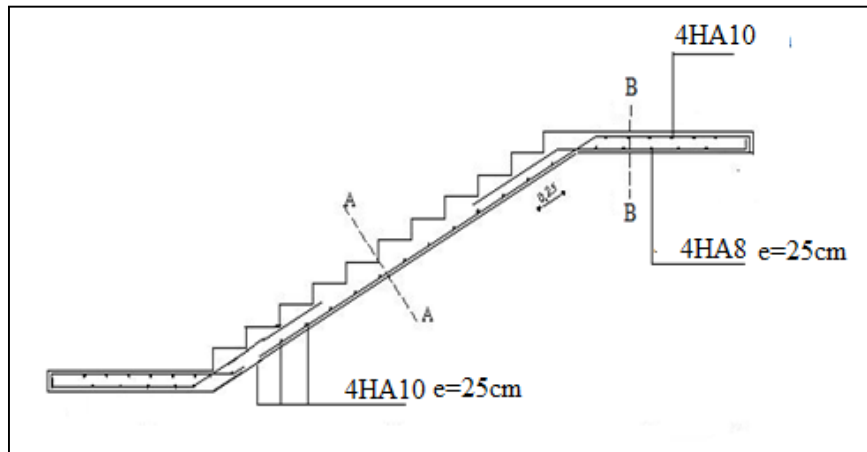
schéma de ferrailage d'escalier type 01 du volée 02
